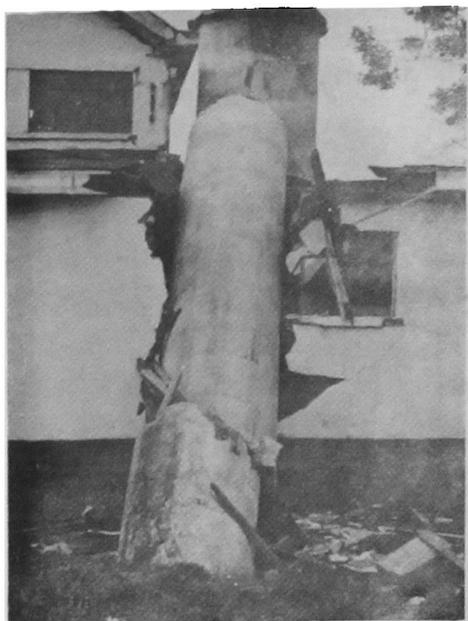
Chimenea de hormigón armado. La rotura se produjo al nivel de una junta. Planta lechera Cayu-mapu.
